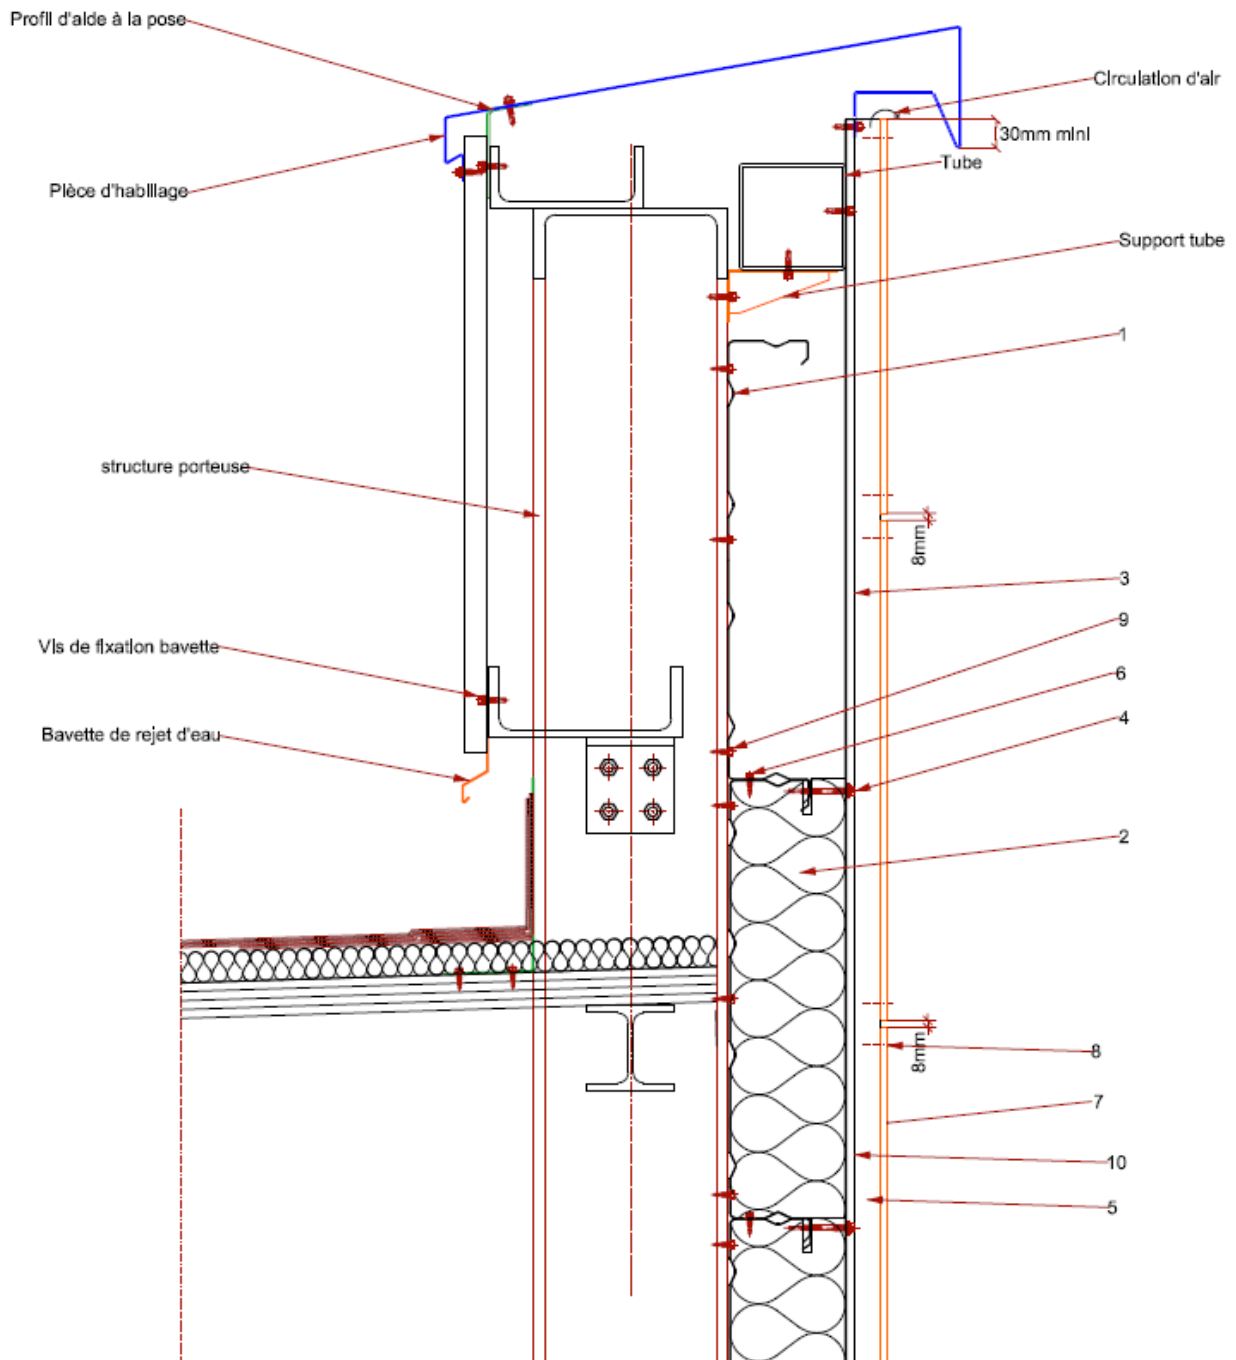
Arrêt sur acrotère (coupe verticale 1)
